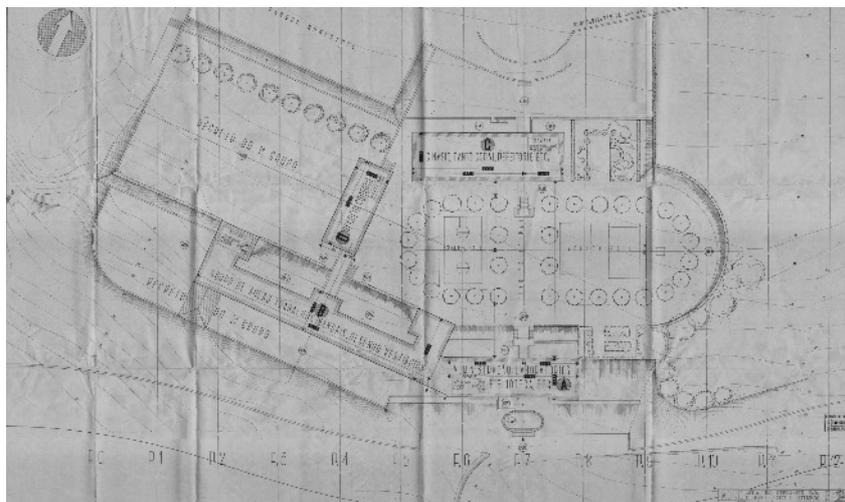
Planta de cobertura - Projeto do Arquiteto Cottinelli Telmo
